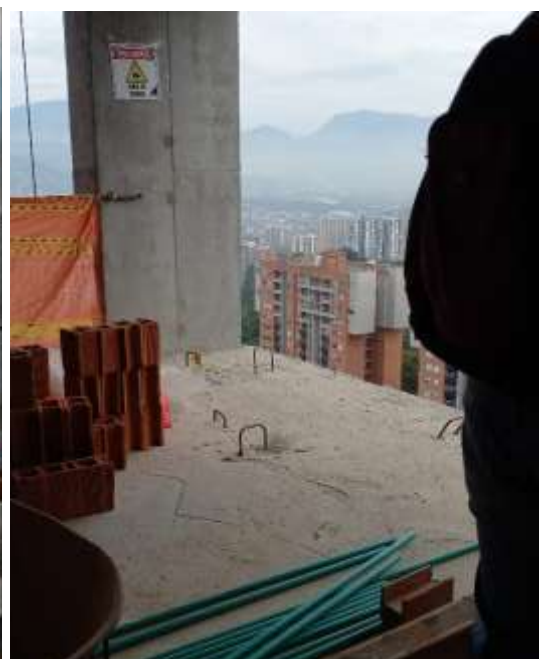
Fotos en anclajes fijos en suelo de estructura de concreto. Archivo del autor
